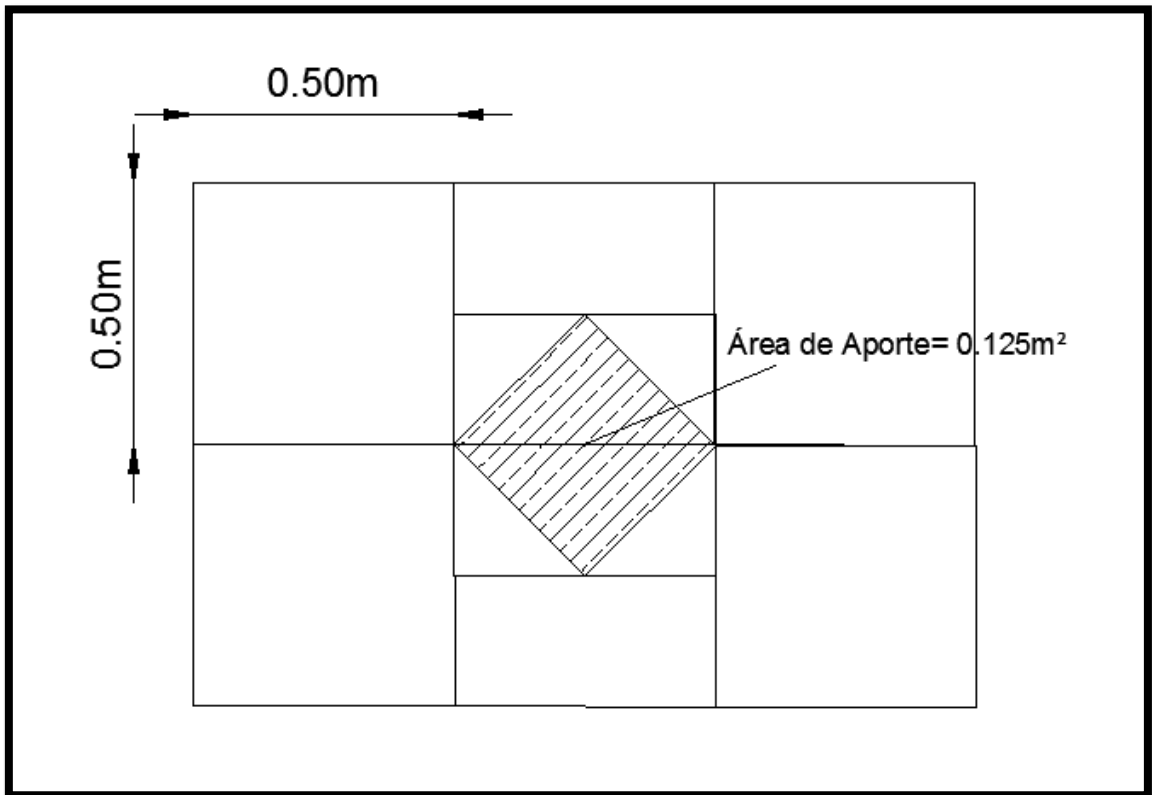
Vista en Planta Pirámide de base cuadrada
